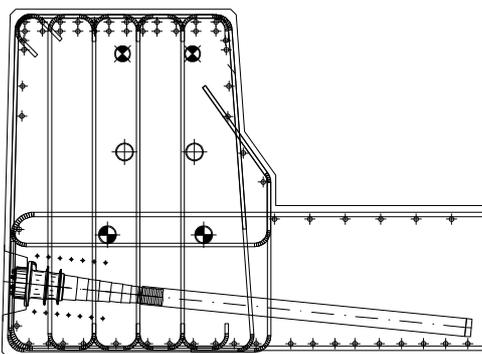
L'armatura della trave laterale nel tratto iniziale
